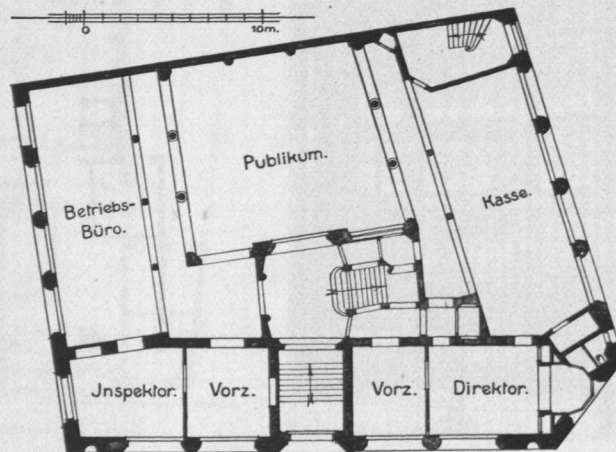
Hamburger Freihafen-Lagerhaus-Gesellschaft, Grundriß.
